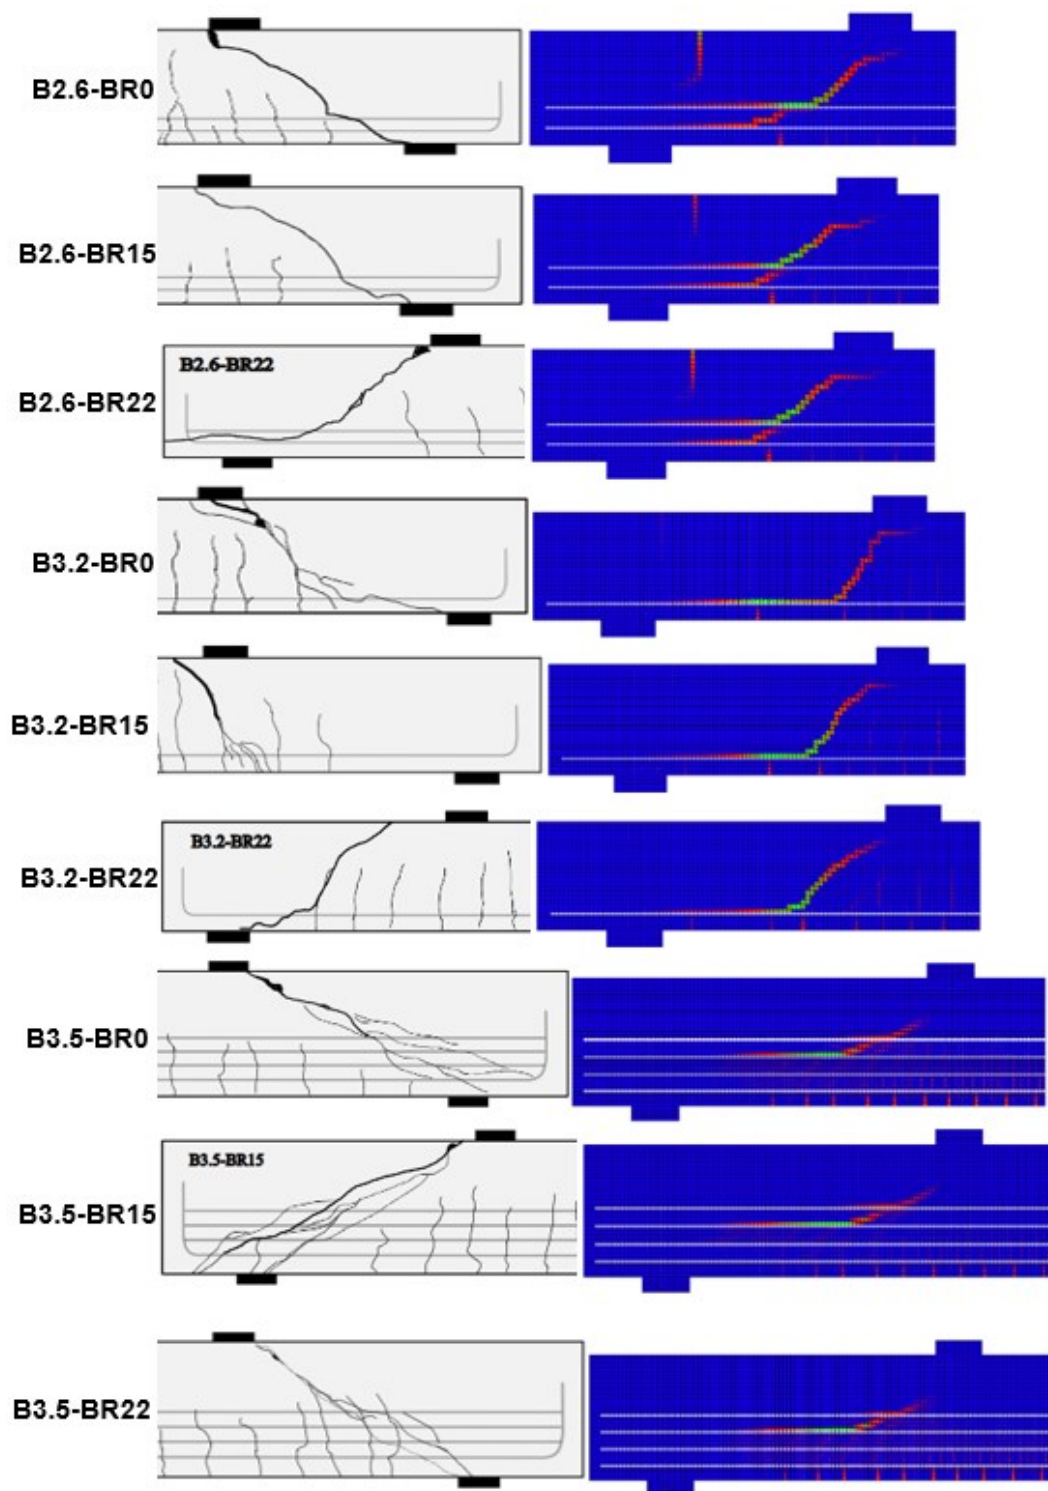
Comparaison de la fissuration pour les poutres B2.6, B3.2 et B3.5
